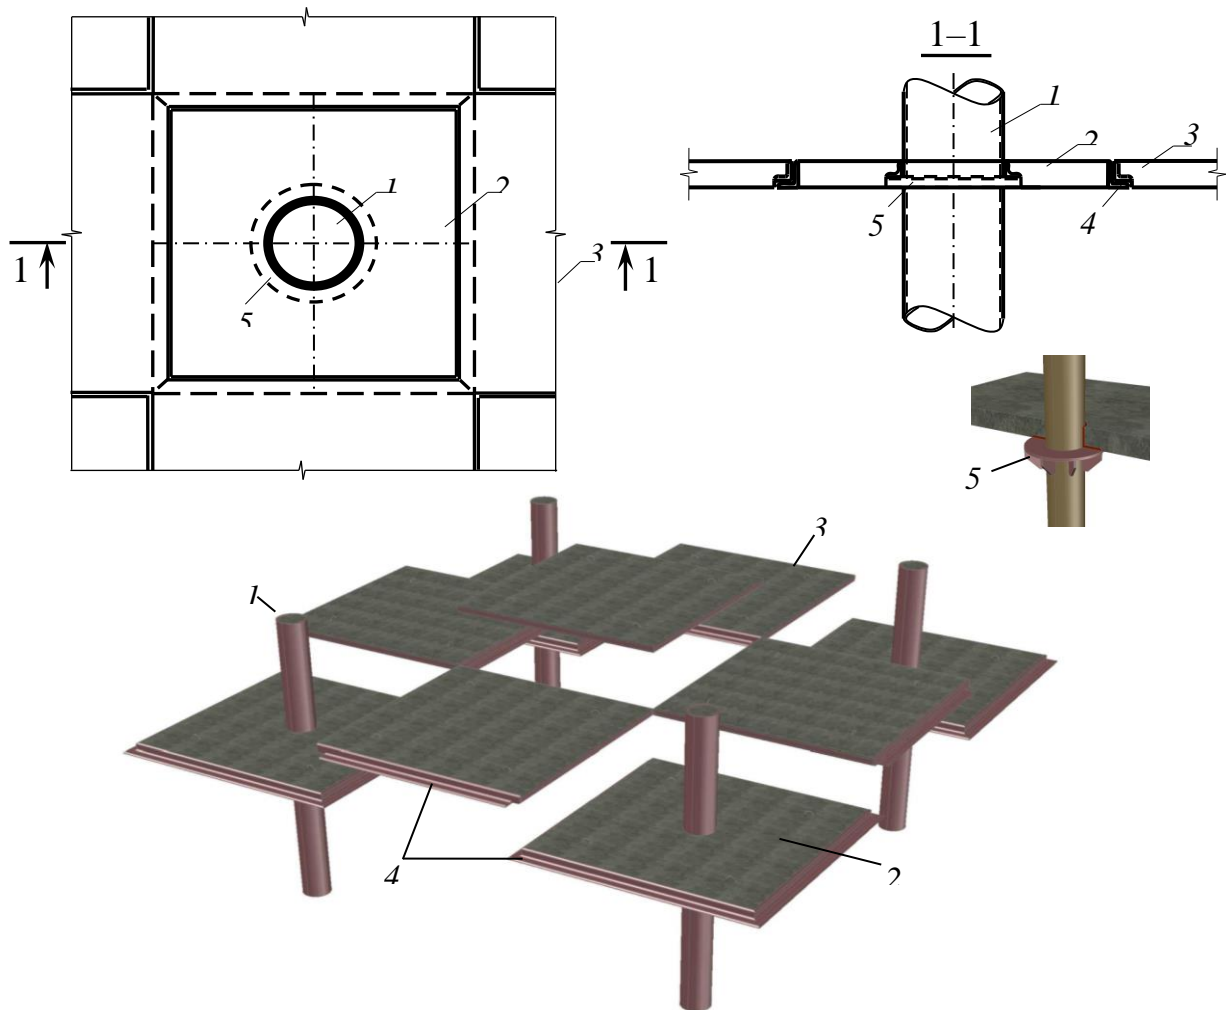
Фрагмент збірного сталезалізобетонного безбалкового перекриття системи А:
